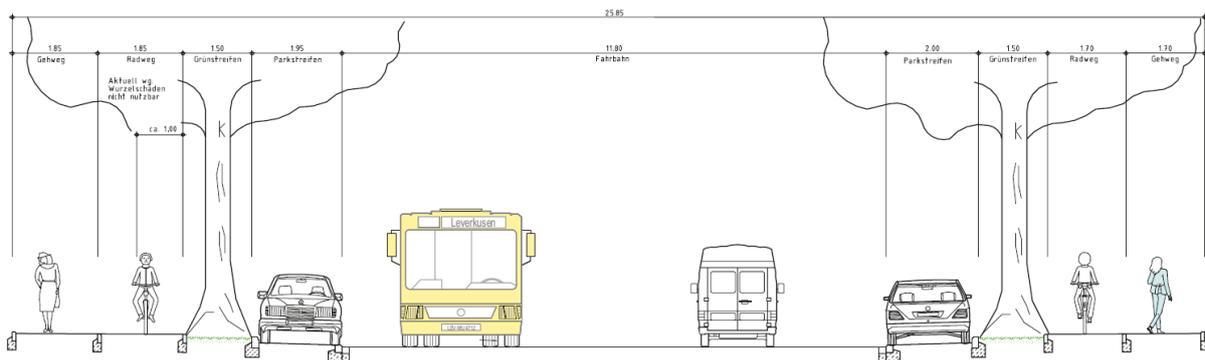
Straßenquerschnitt zwischen Franz-Marc-Straße und Wolf-Vostell-Straße – Blickrichtung Berliner Straße
